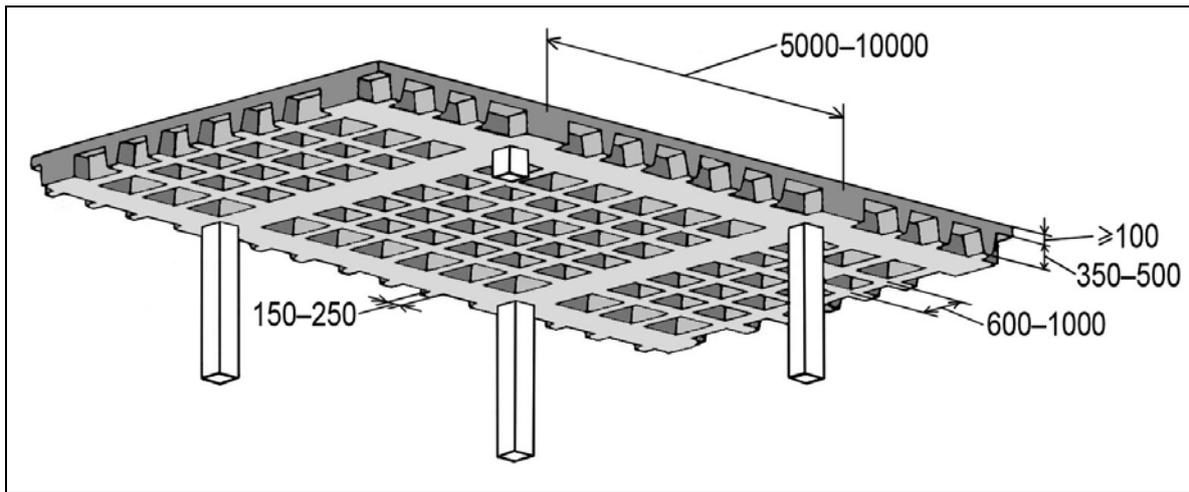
Вариант монолитного кессонного железобетонного перекрытия, указаны ориентировочные размеры
